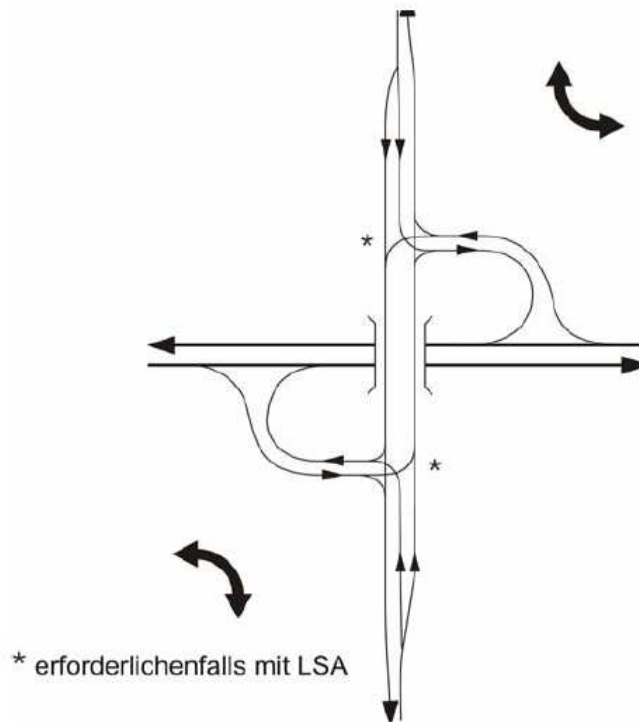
diagonales halbes Kleeblatt mit Ausfahrt vor dem Kreuzungsbauwerk aus RAA
